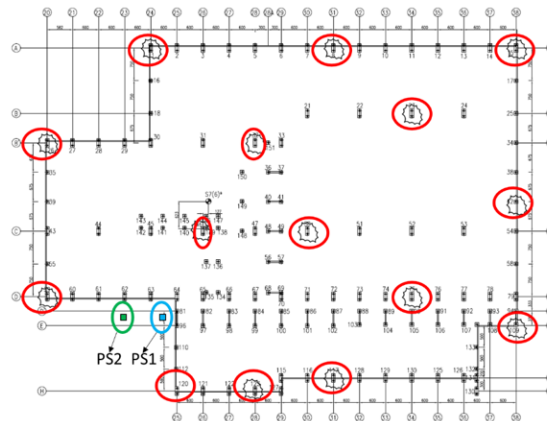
Vista en planta Nave de Industrial 01, Pilotes instrumentados con PDA en etapa de mapeo.
